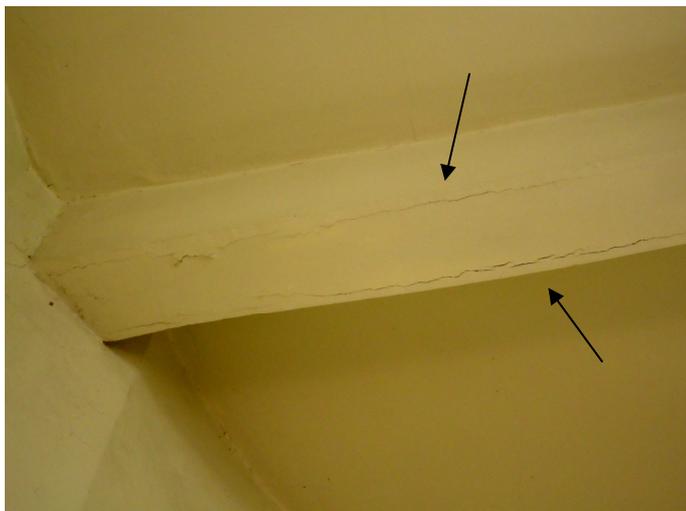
Fissuração no guarda-corpo da sacada
